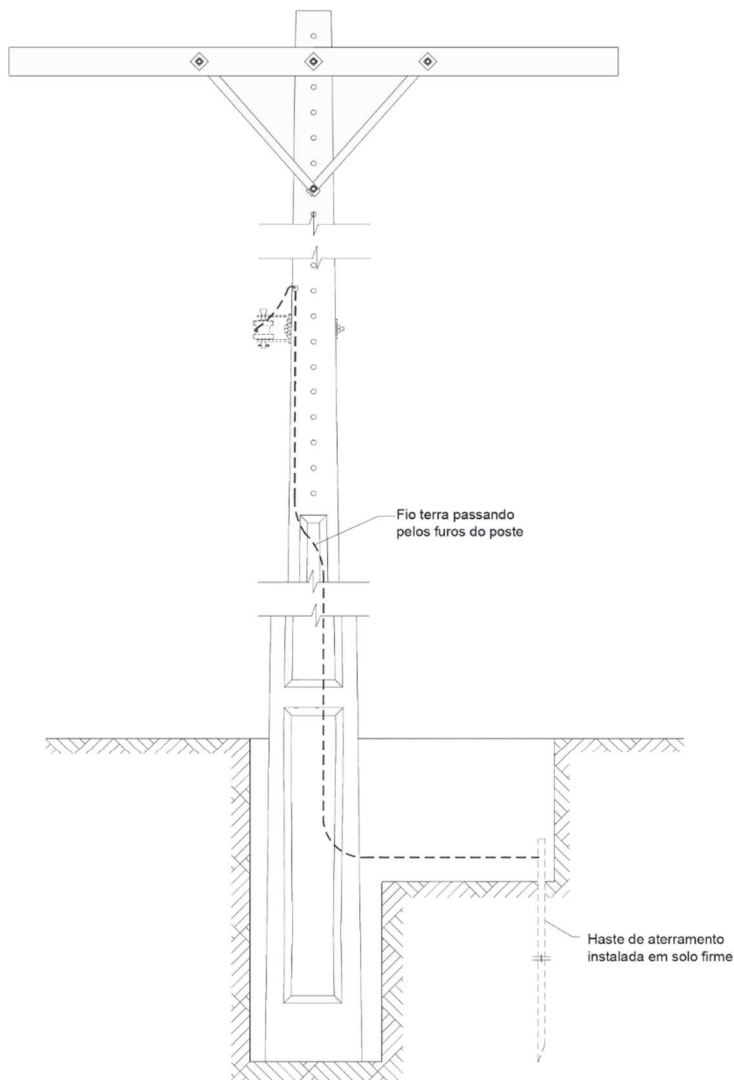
Amarrações e ligações – Amarração e ligação à terra – Poste de concreto
